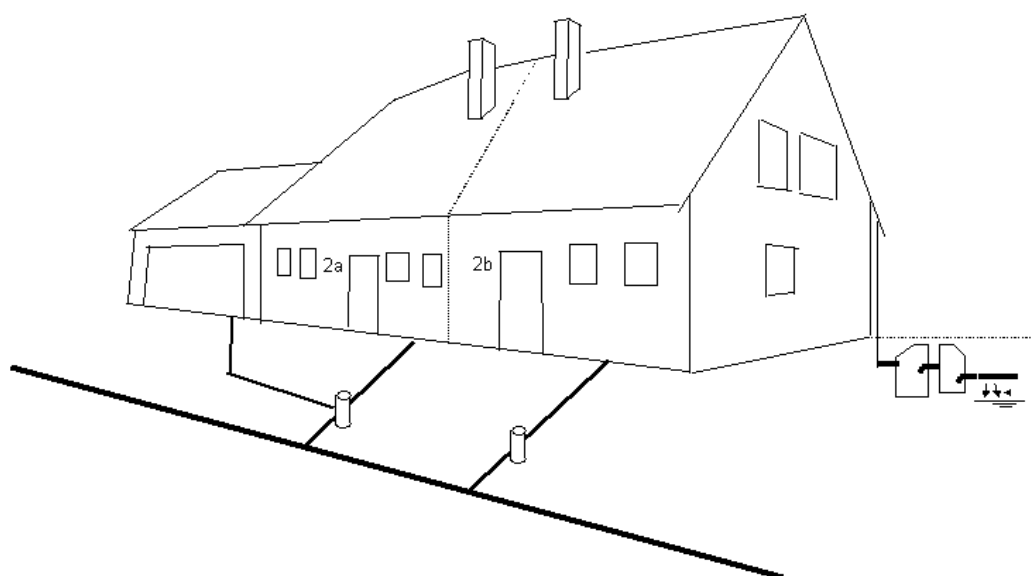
Exemple de maisons jumelées : donnent droit à des subventions deux bâtiments avec le relevé de l'état de deux raccordements, une conduite d'évacuation des eaux d'un garage et une installation d'infiltration
